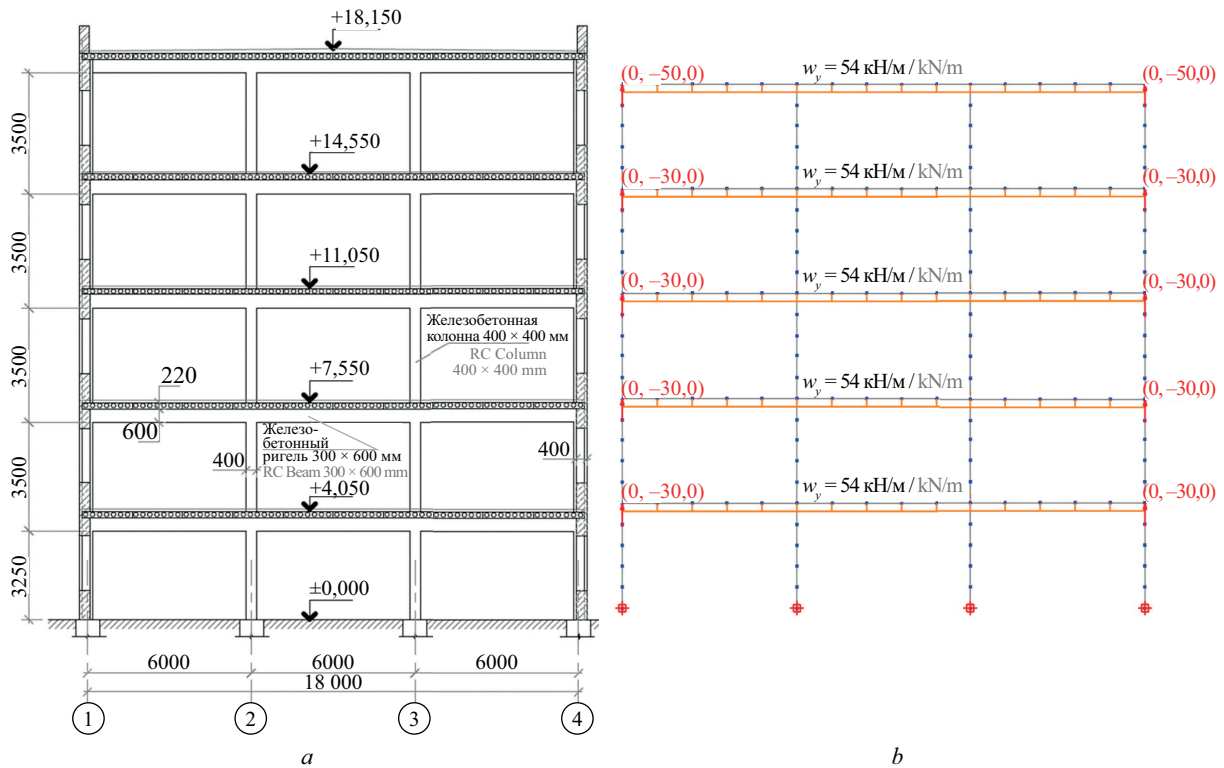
Конструктивная (а) и расчетная (b) схемы железобетонной рамы
